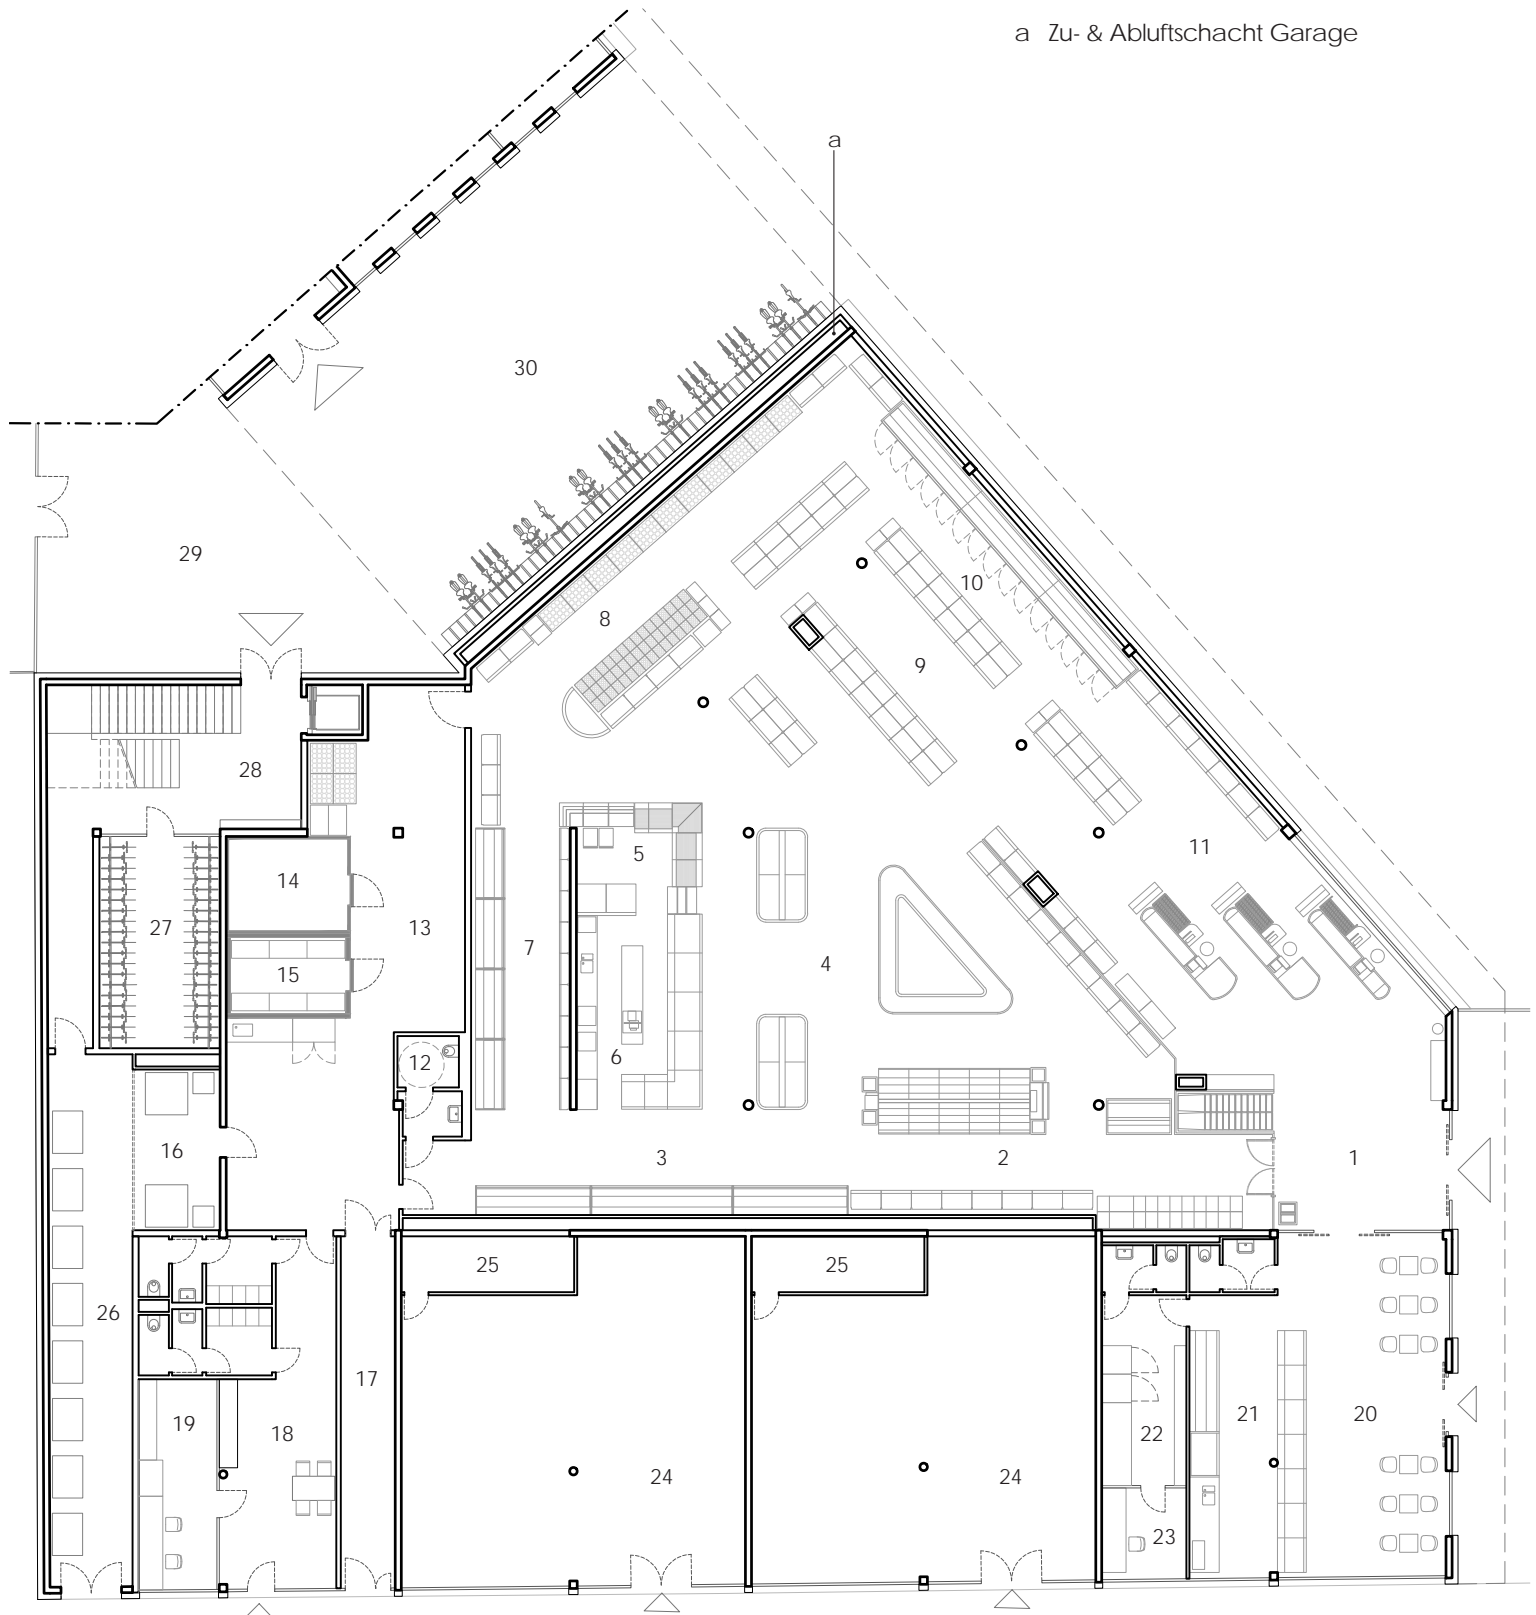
Grundriss Erdgeschoss - Bereich Nahversorger.
